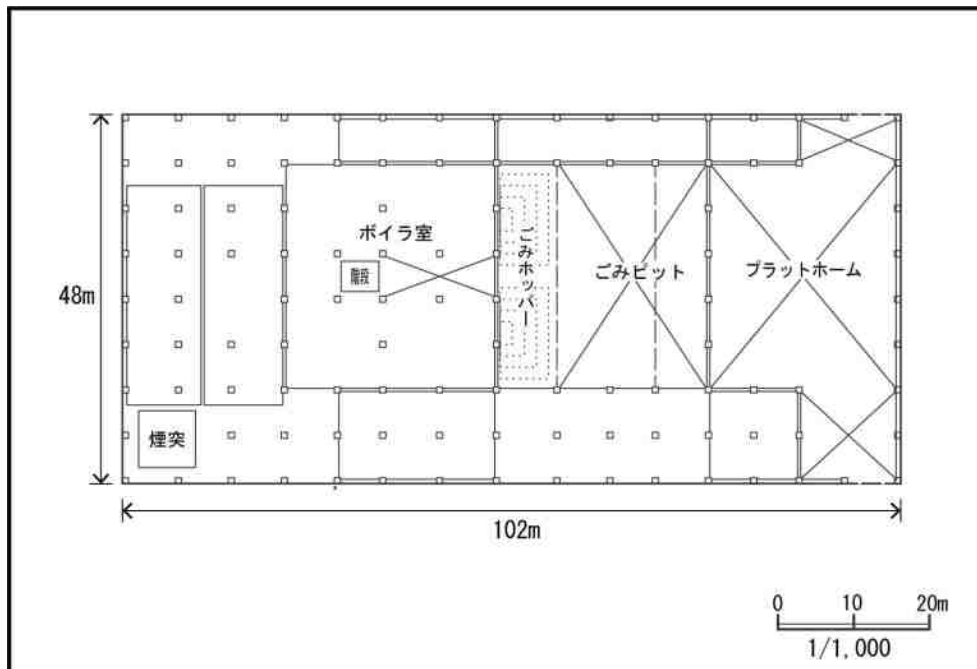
(4) 新施設の平面図（新焼却処理施設 3 階）
